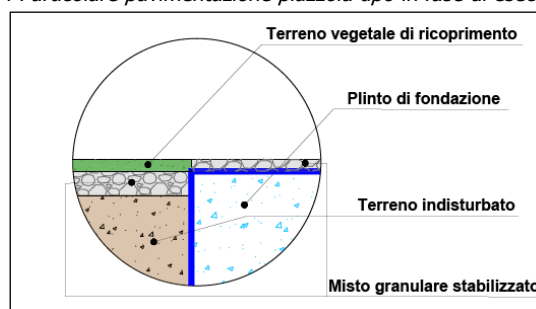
Particolare pavimentazione piazzola tipo in fase di esercizio
